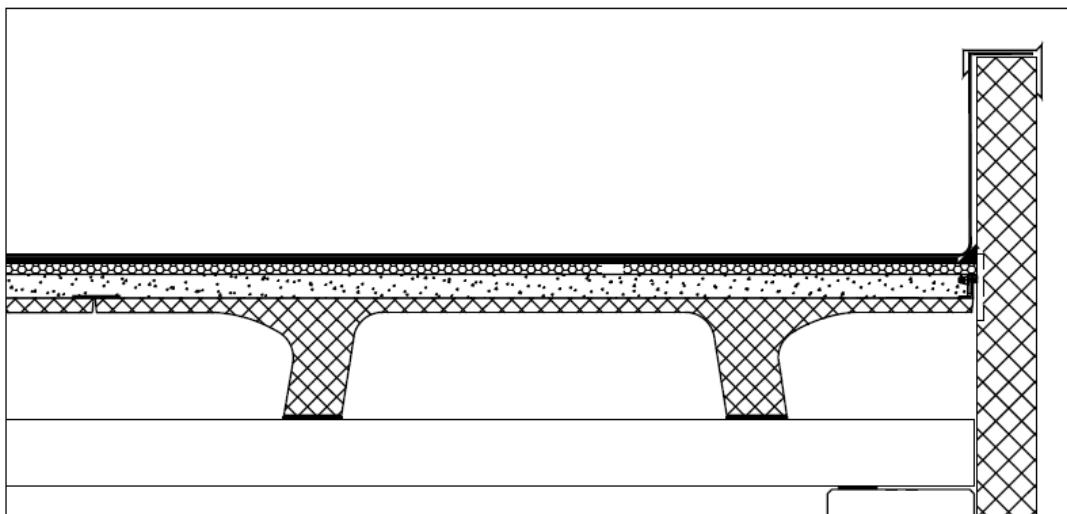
Detalhe de elemento de cobertura/pavimento – Armazém/Serviço pessoal
